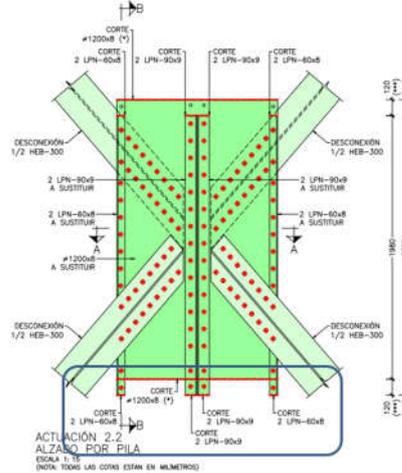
Nudo intermedio mamparo de pila. Corte de angulares
